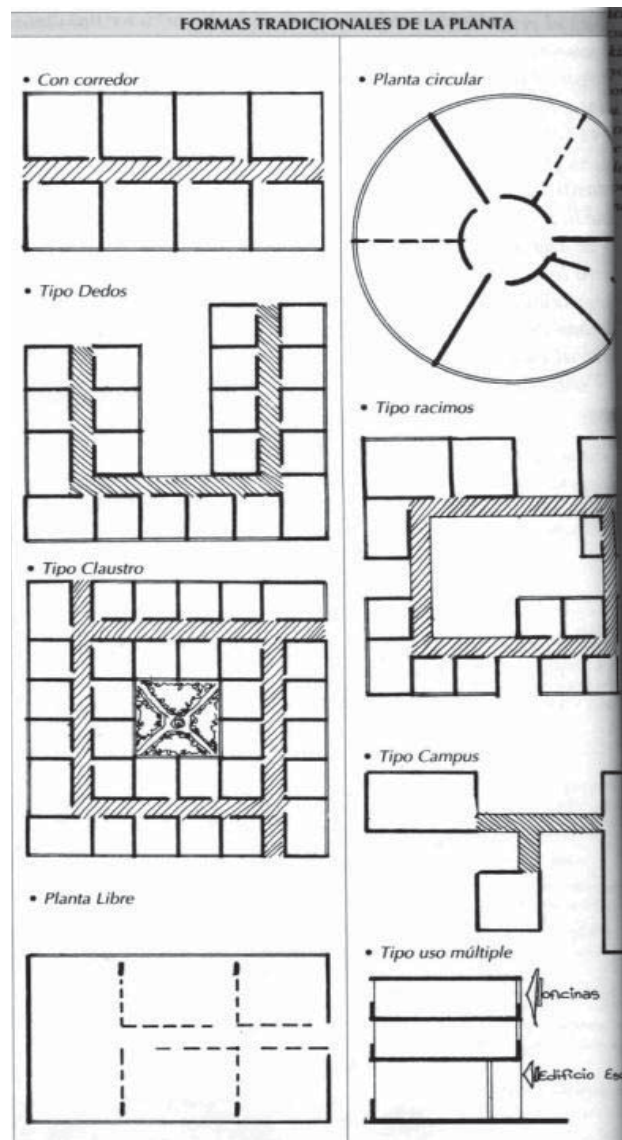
Tipos tradicionales de planta. Arquitectura escolar ESCALA, Editorial Escala, Colombia, pp. 7
